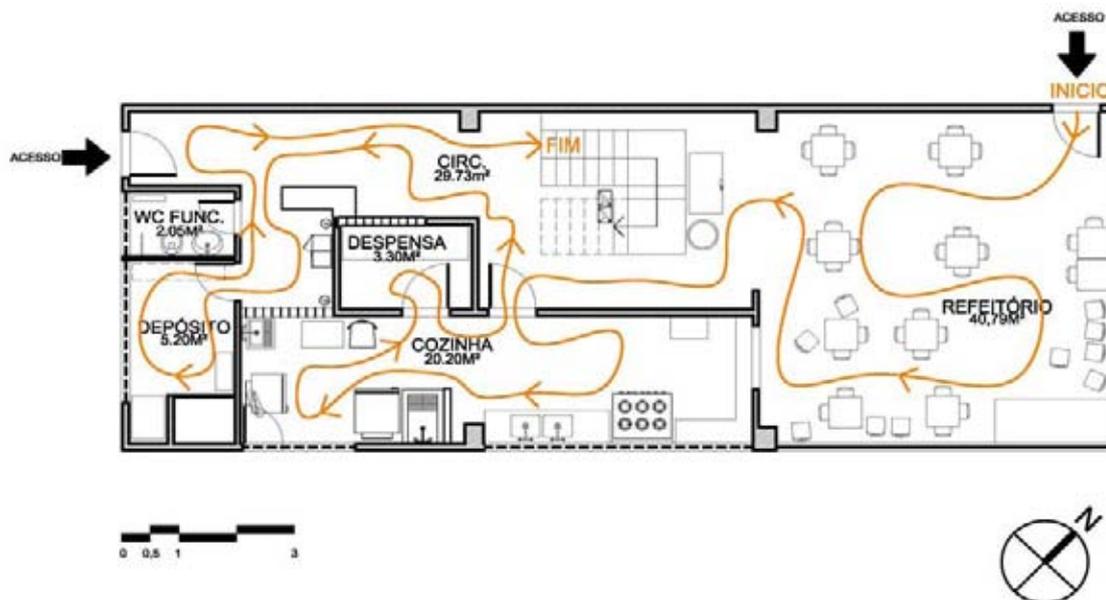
Percurso 1 – INÍCIO da Walkthrough – “Bloco 2”, 1º pavimento.
